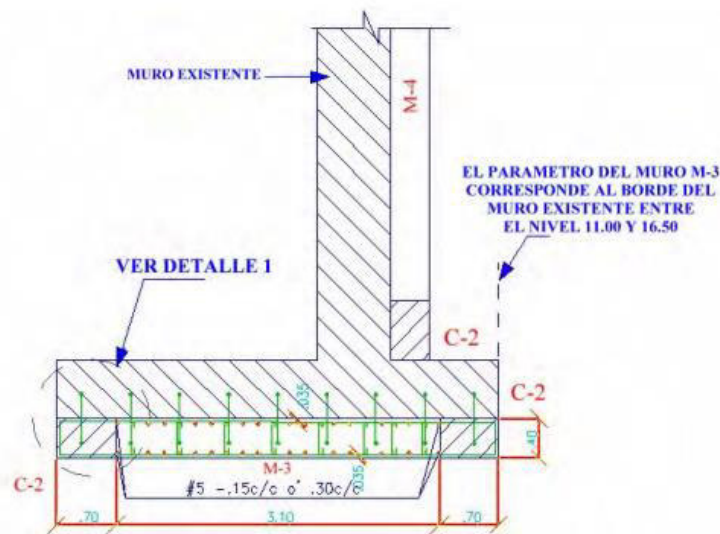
Detalle de Reforzamiento en la cimentación
